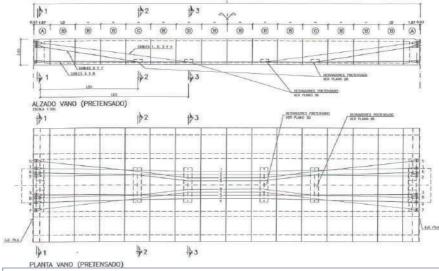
Alzado y planta del vano tipo con sus dovelas constitutivas y pretensado exterior
